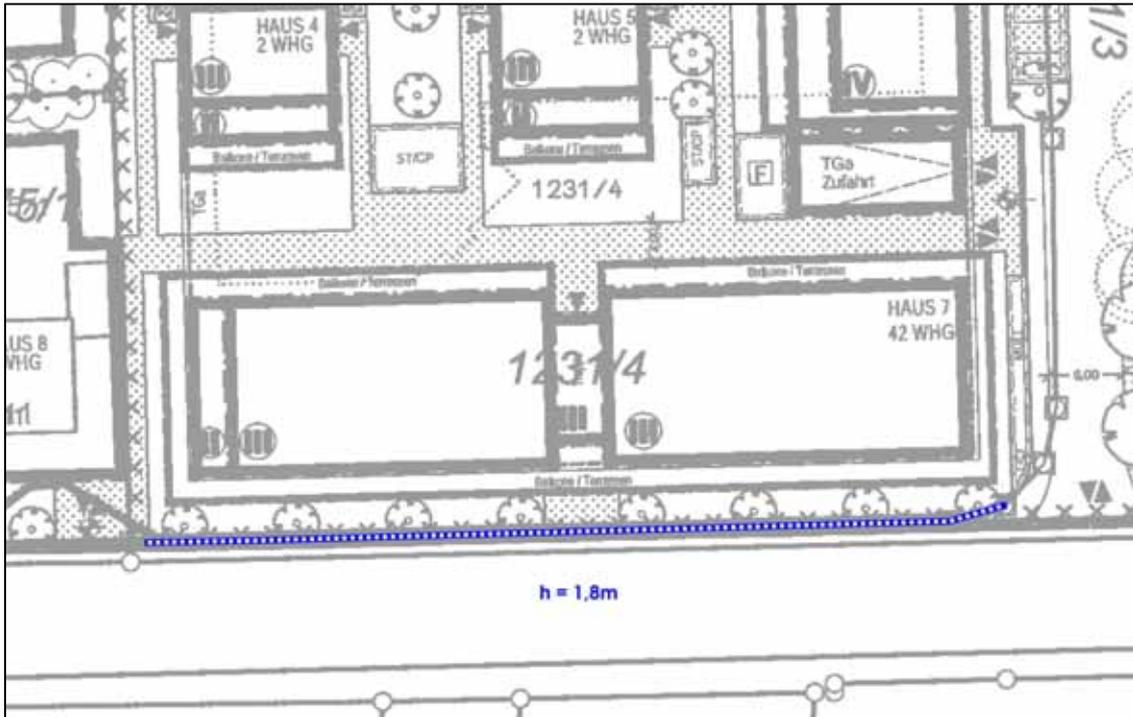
Lageplan mit Darstellung der Lärmschutzwand parallel zur Kelheimwinzerstraße
